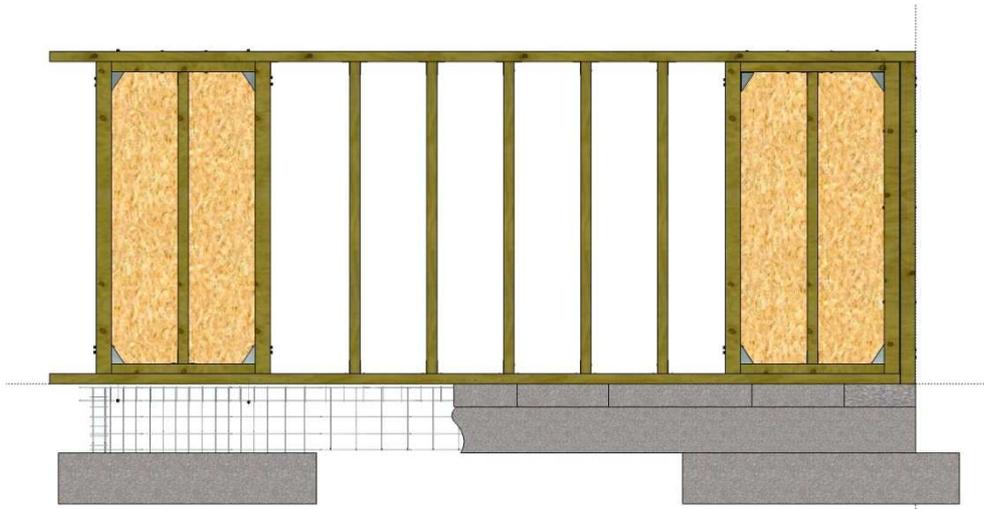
Exemple de panneaux de contreventement VT sur fondation de type semelle isolée reliée par longrine
